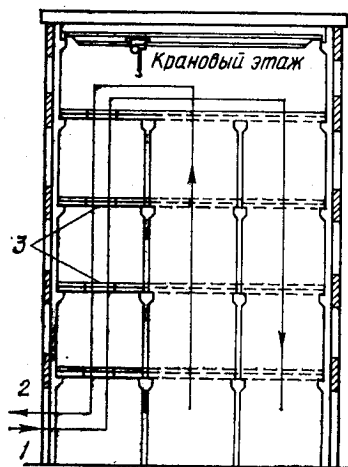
Схема монтажа и демонтажа конструкций с использованием грузоподъемного оборудования в крановом этаже:
